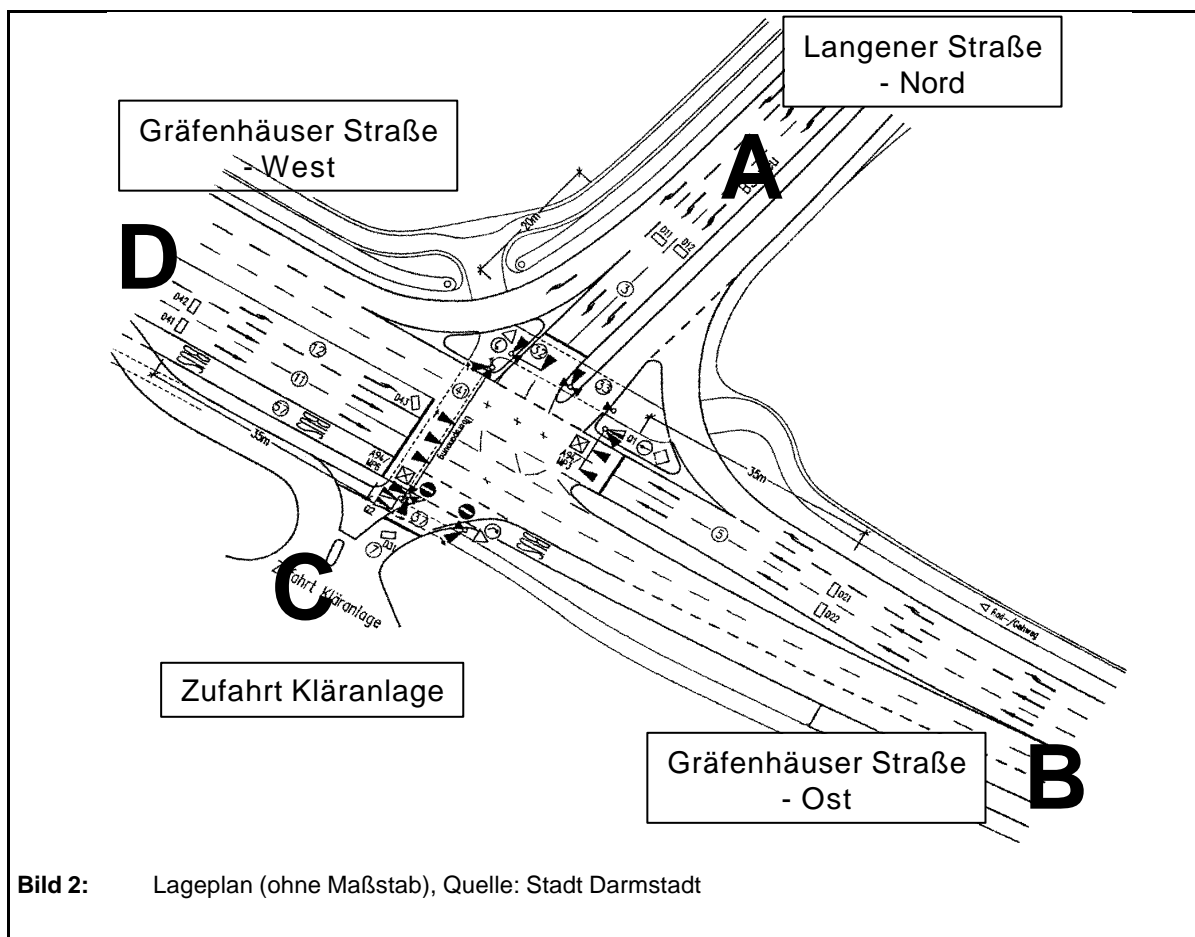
Lageplan (ohne Maßstab), Quelle: Stadt Darmstadt
